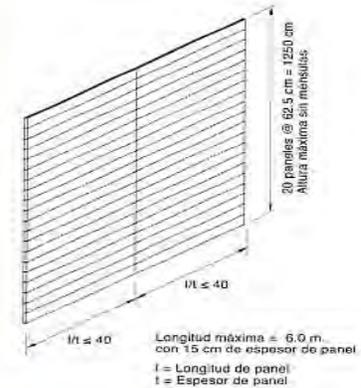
Arreglo horizontal de paneles para muro Contec.
